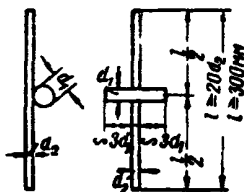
Образец из стали, упрочненной холодными способами, для испытания на растяжение
